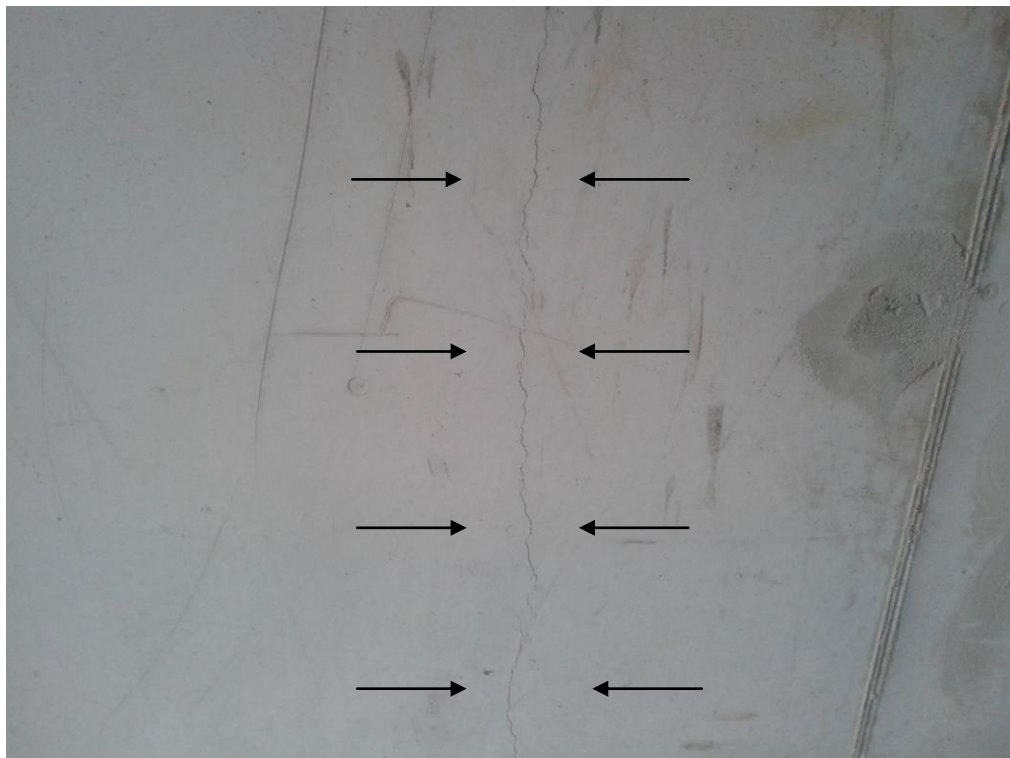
Fissura parede: Fissuras em paredes sem abertura
